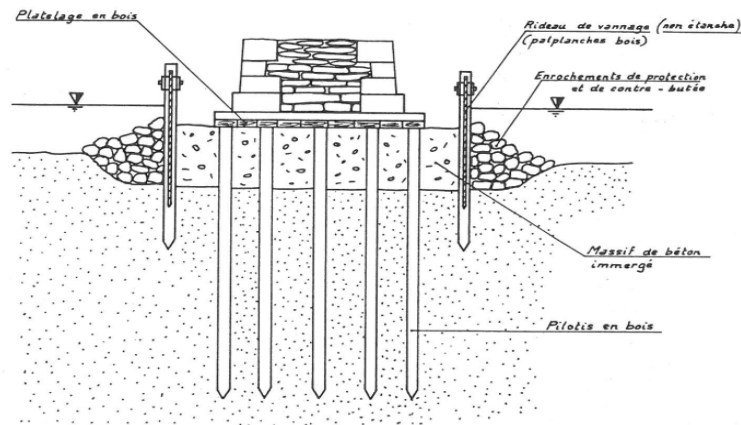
Fondations sur pieux enserrés dans un massif en béton immergé (Levillain, 1980)
